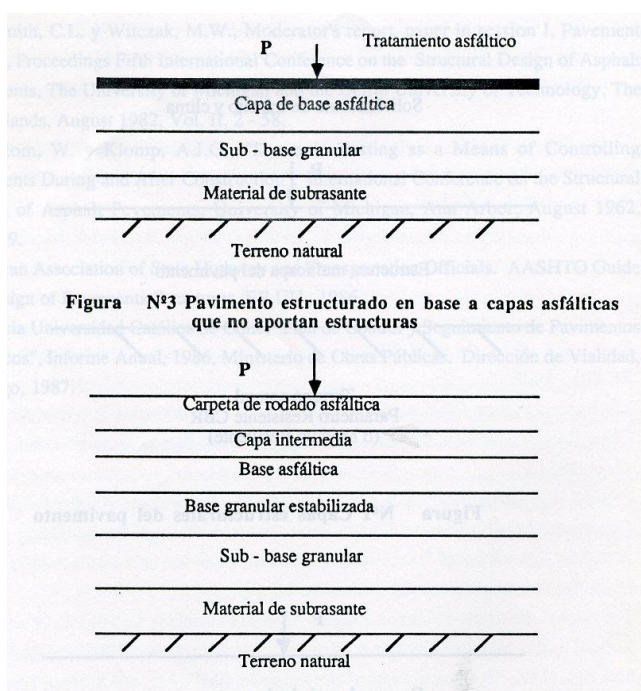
Pavimento estructurado en base a capas asfálticas que no aportan estructuras
